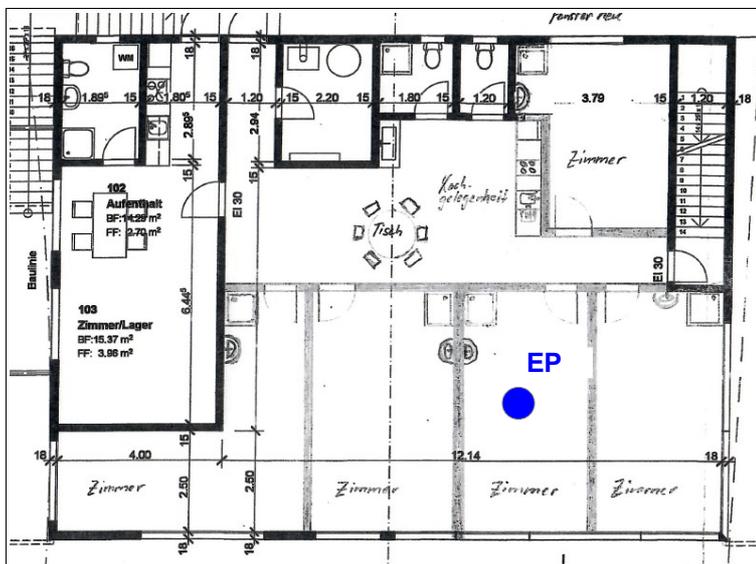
Grundriss OG, ohne Mst.; Quelle: Auftraggeber
